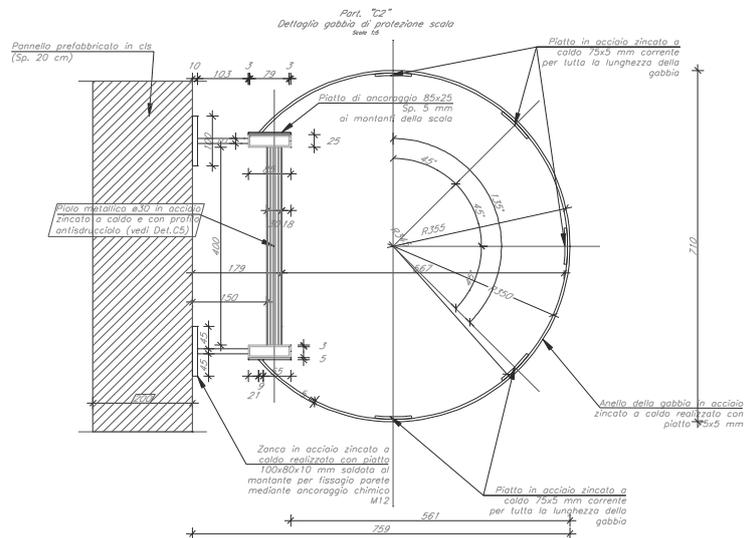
Scale a pioli con gabbia – sezione vista dall'alto
